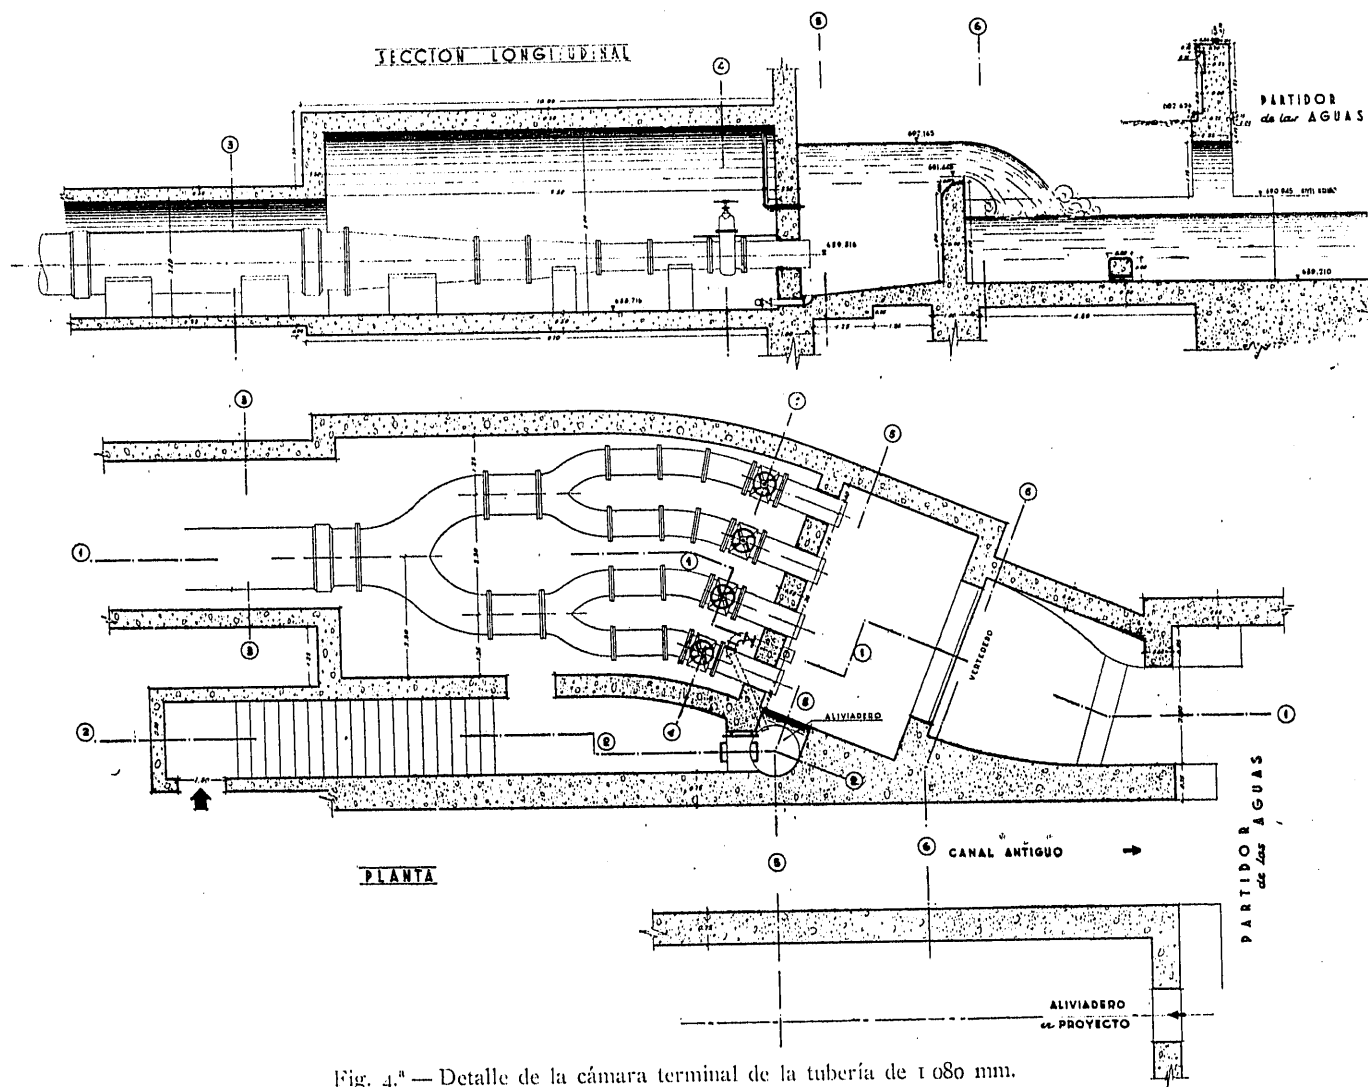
^a — Detalle de la cámara terminal de la tubería de 1080 mm.
